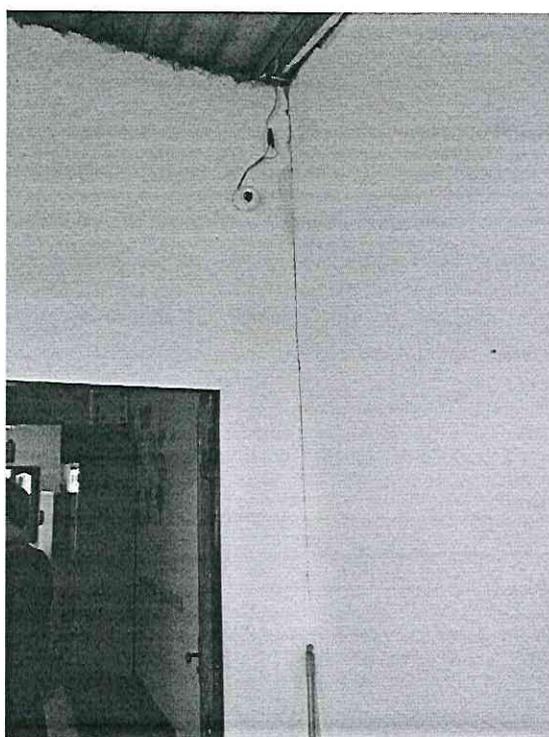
REPARO DE FISSURA NA PAREDE
